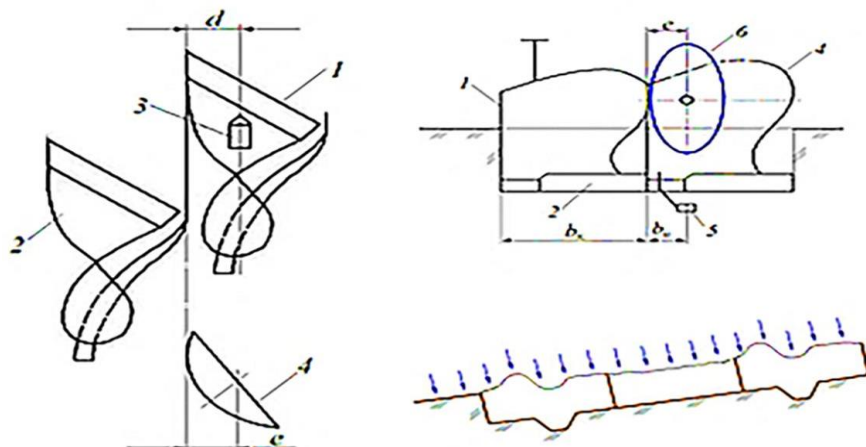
Взаимное расположение корпуса, рыхлителя и сферического диска (а), поперечное сечение поля после обработки плугом (б): 1 – передний корпус; 2 – второй; 3 – плуг; 4 – глубокорыхлитель; 5 – диск.
